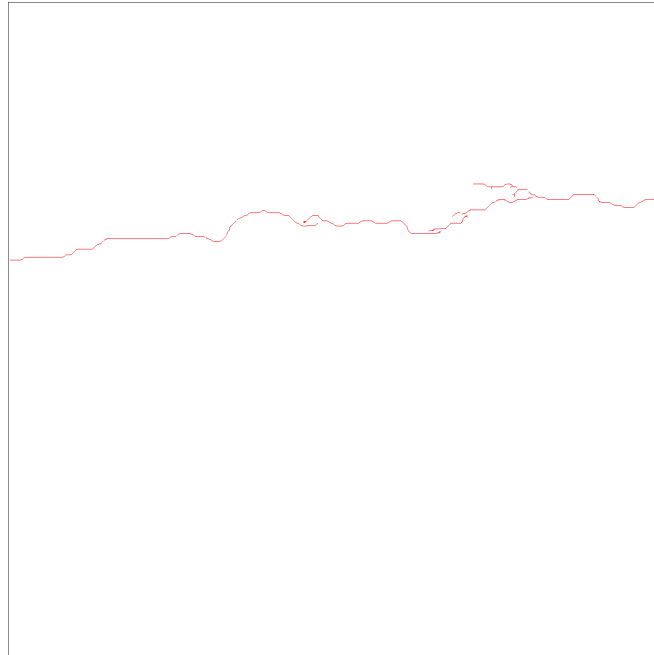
Position des chemins de fissuration en traction du béton B1-12
